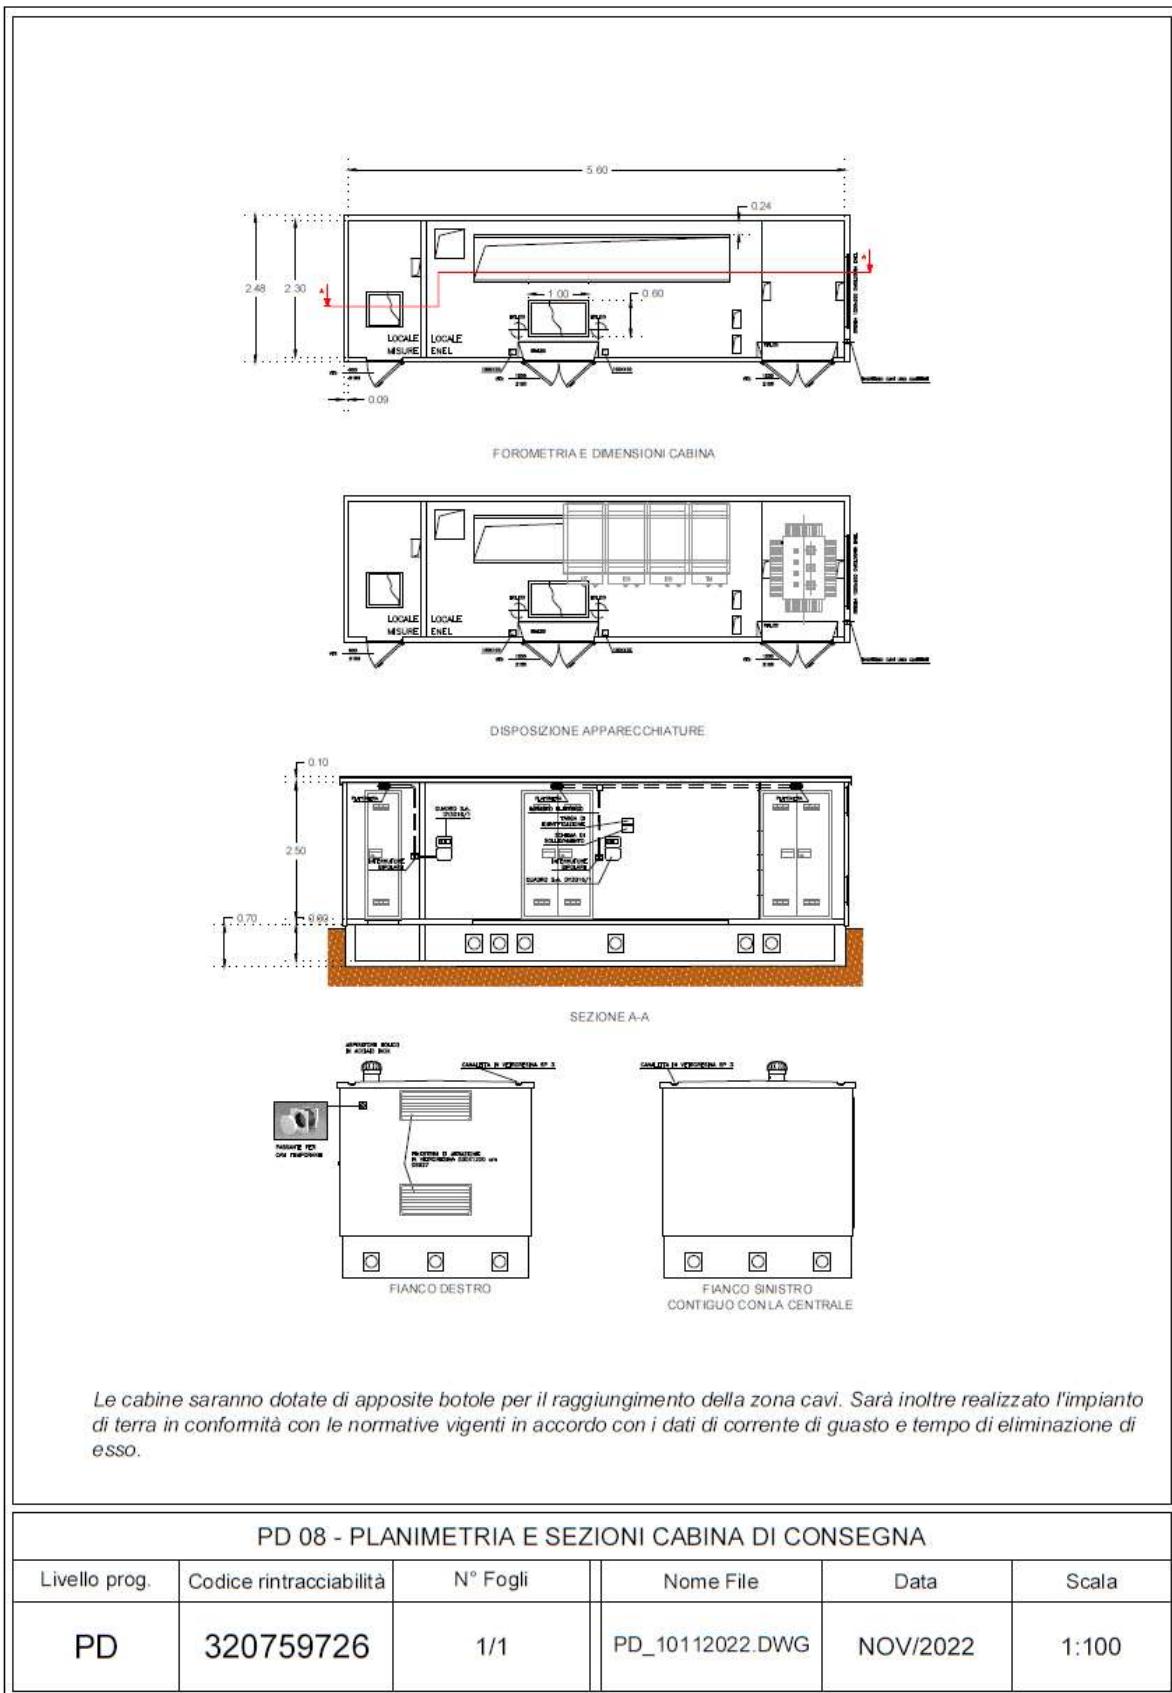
Estratto dal Progetto definitivo dell'impianto di rete - Elaborato grafico della cabina di consegna posta a nord di Longarone (località Castellavazzo)
